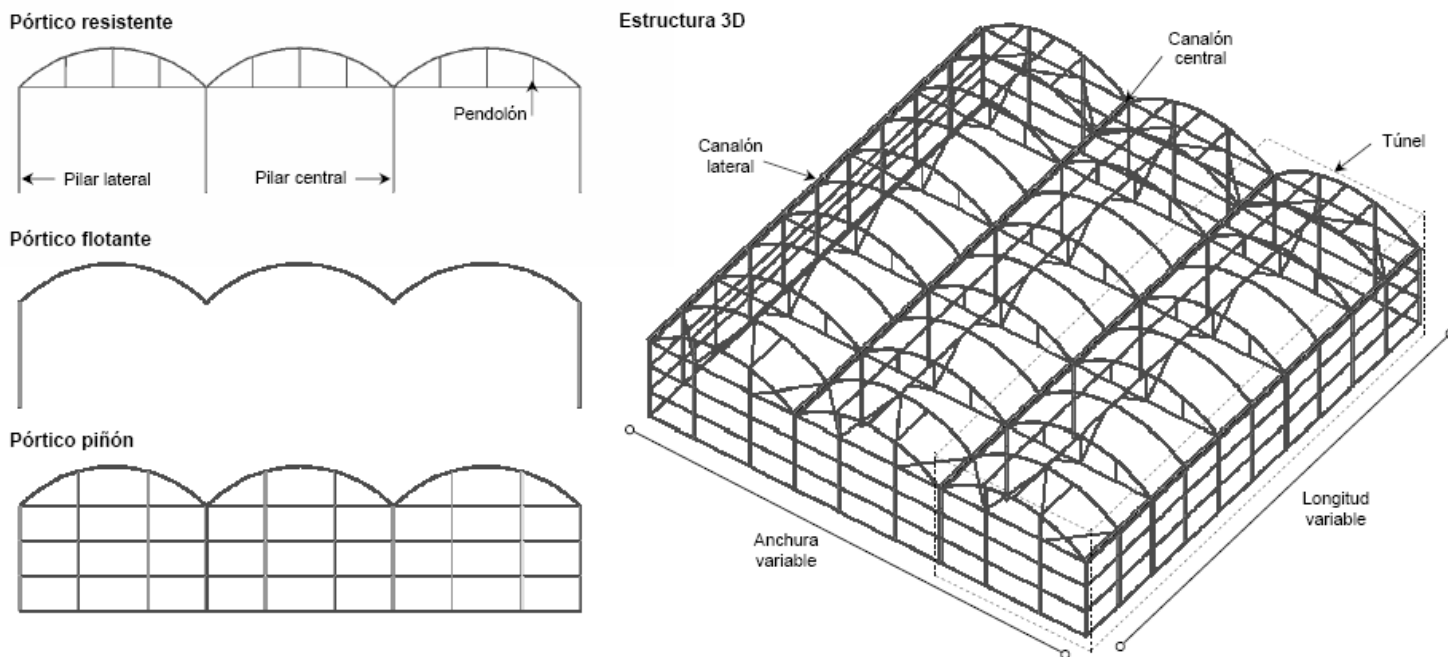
Alzados de los tres pórticos tipo y vista tridimensional de las estructuras estudiadas.
